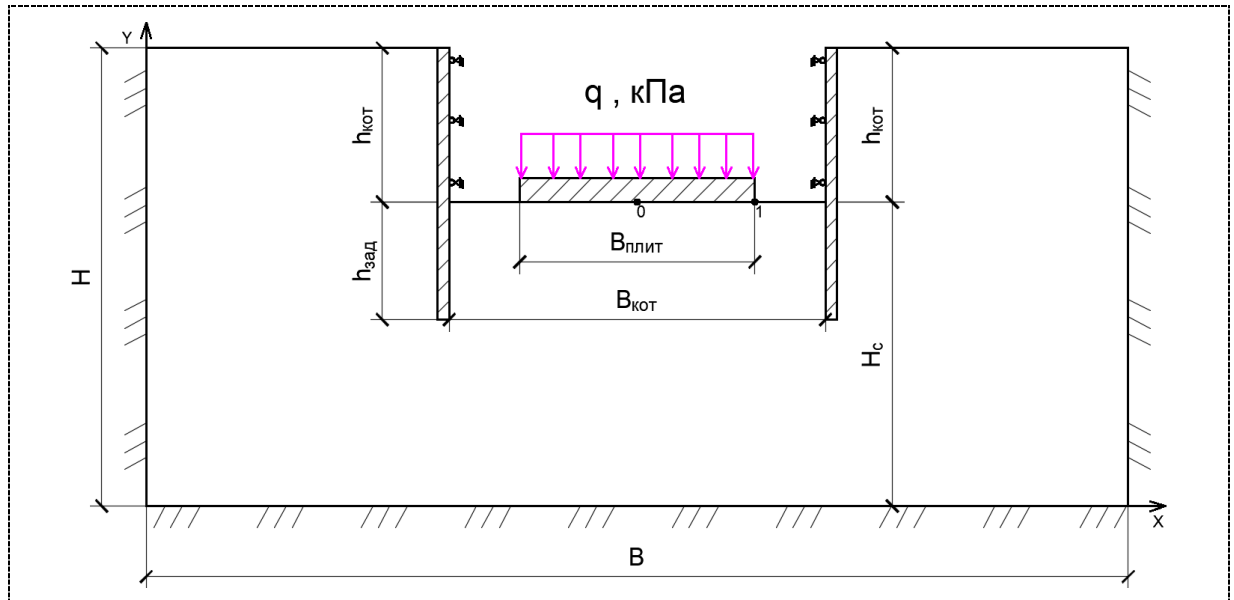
Расчетная схема для случая расположения здания в центре строительной площадки
